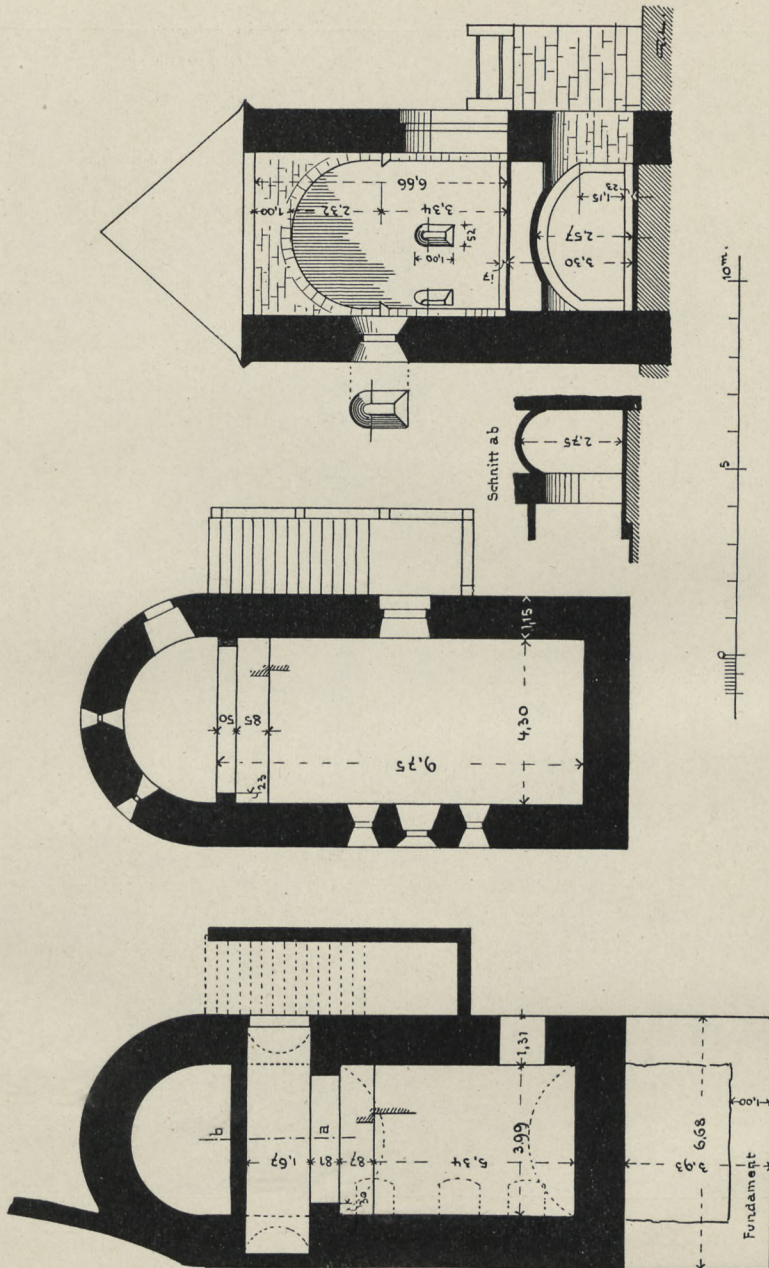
Breitenstein. Grundrisse und Schnitte der Schloßkapelle.
